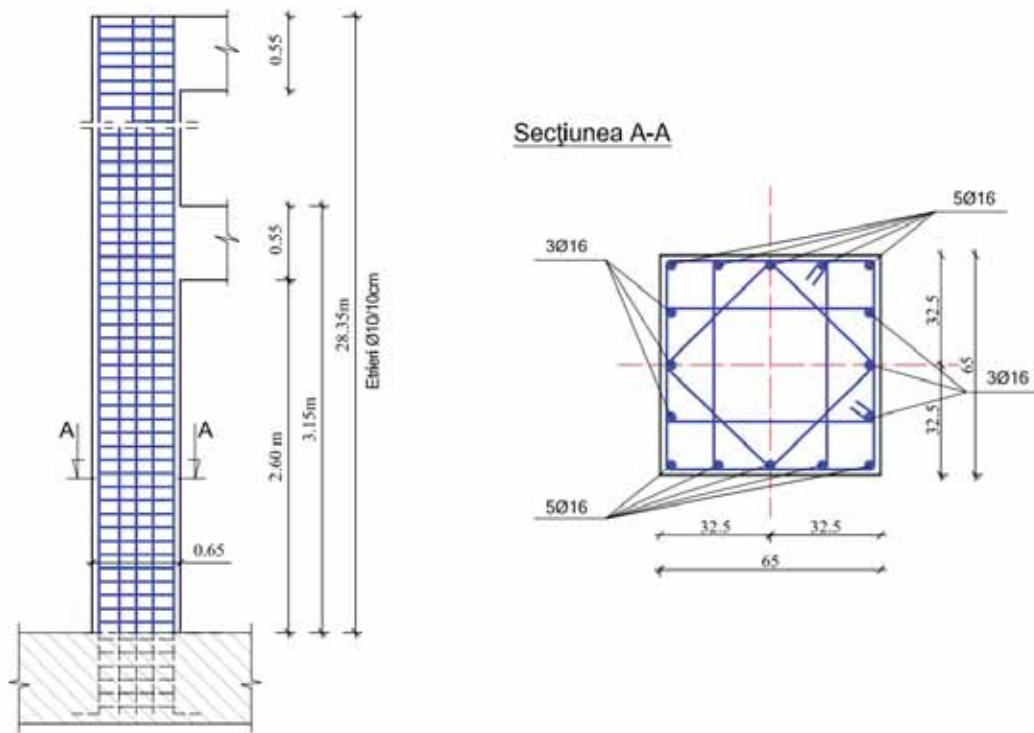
Structură P+8E: plan armare stâlp b.a.
